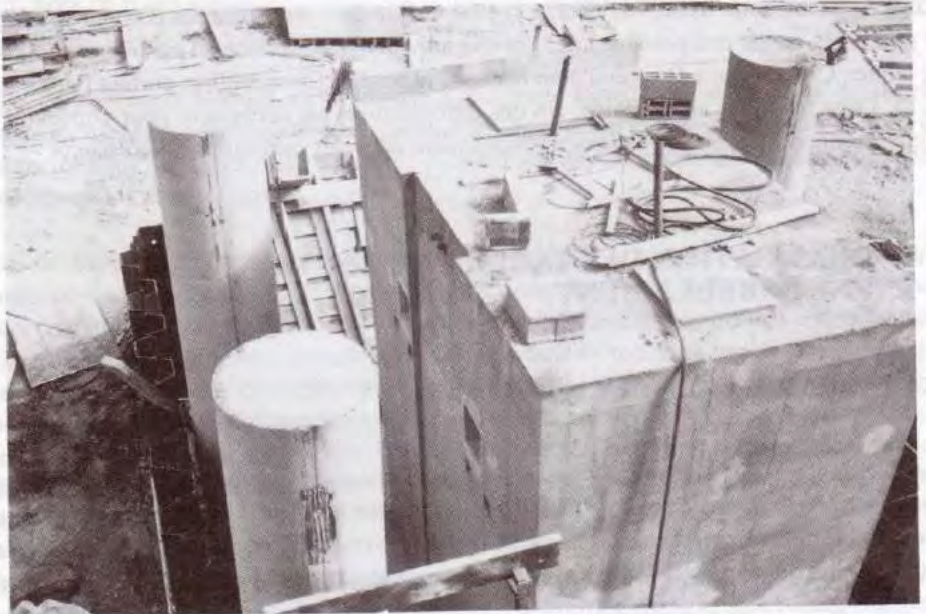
Poteaux de stabilisation autour d'une pile (photo JAC).
